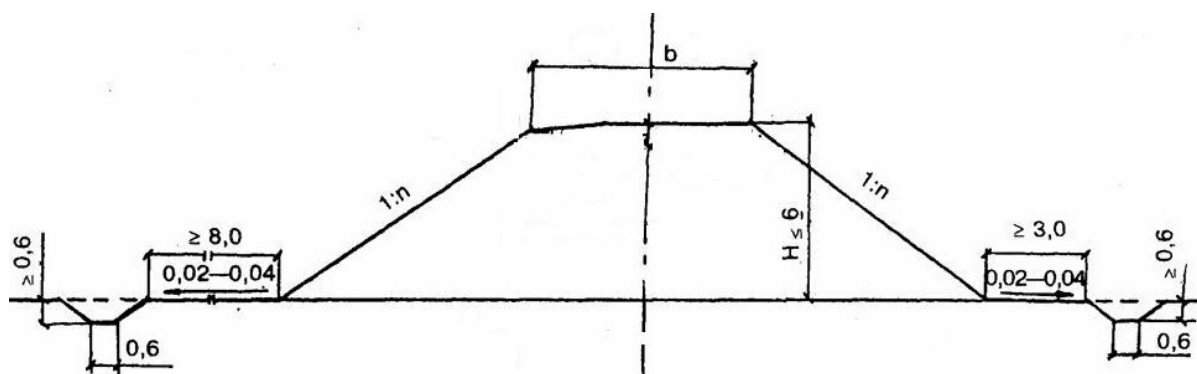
Поперечный профиль насыпи из недренирующих грунтов [25]
